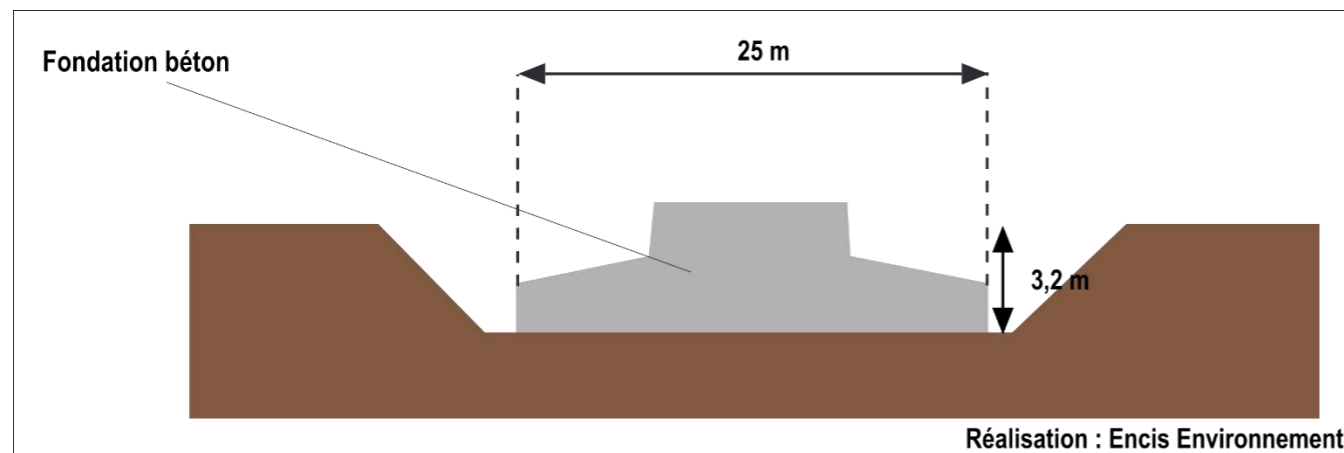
Schéma d'une fondation d'éolienne NORDEX N149
